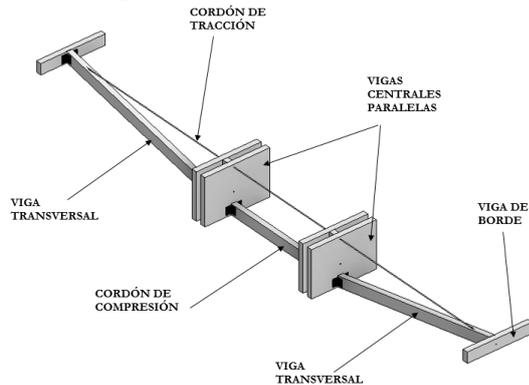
Módulo tipo del sistema estructural de núcleo central. Fuente: SENER Ingeniería.
